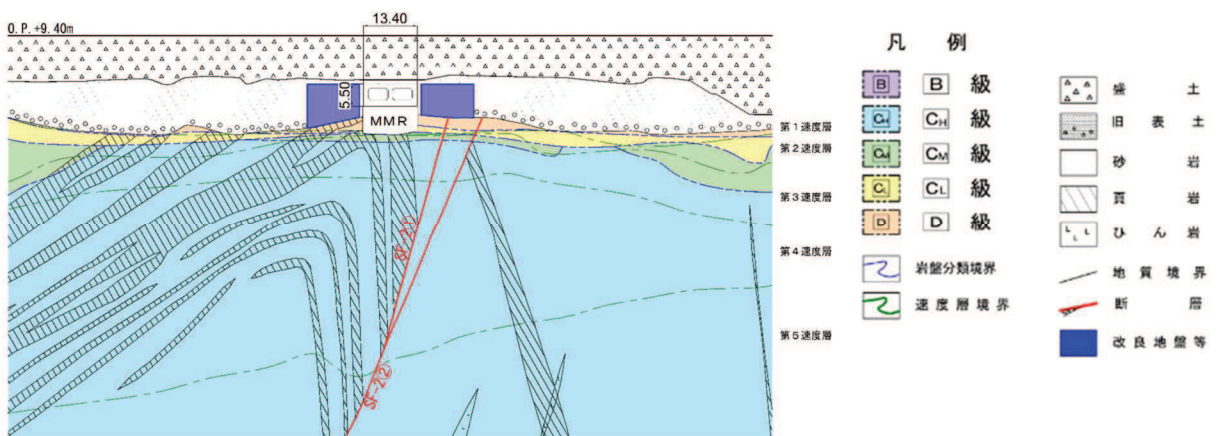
地盤改良体の配置図 (取水路, B-B 断面)
